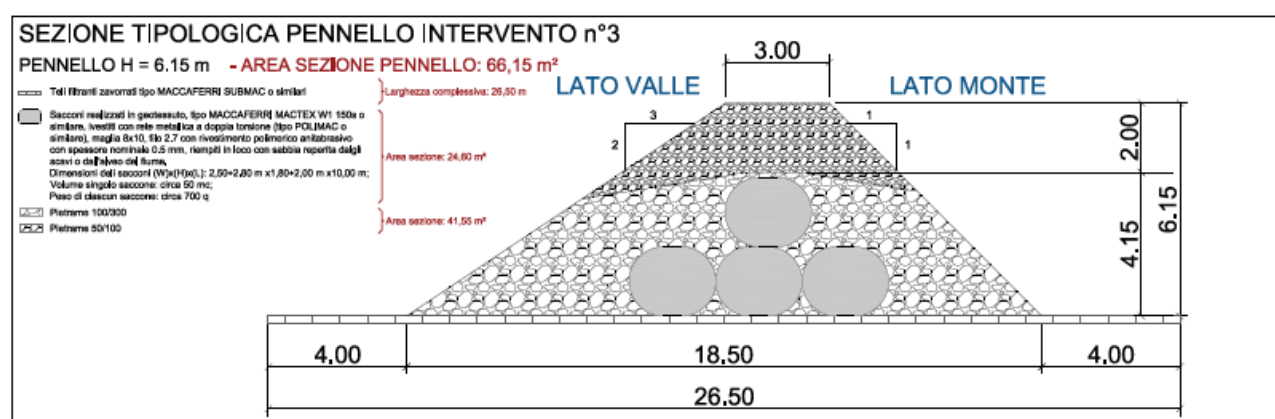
Sezione tipologica esemplificativa delle opere in progetto
